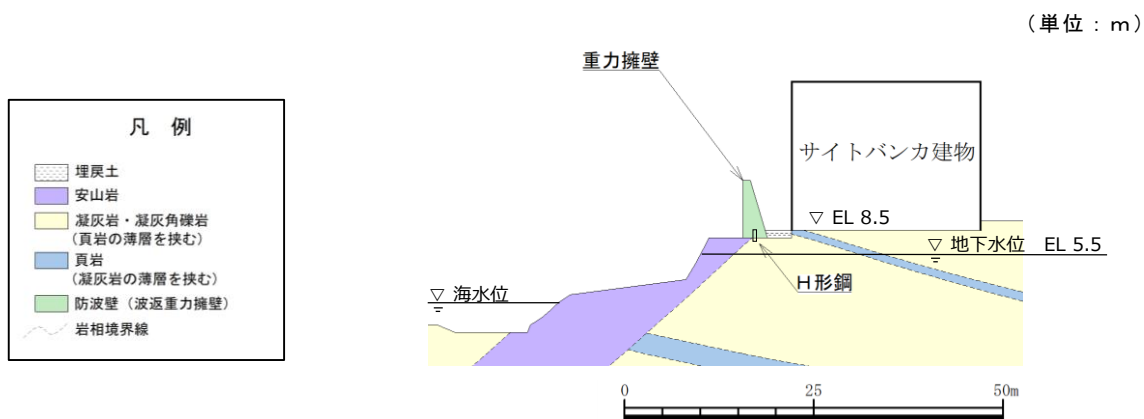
防波壁 (波返重力擁壁) の横断面図 (⑤-⑤断面)
